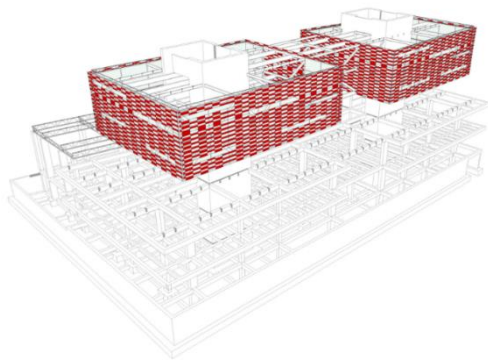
Axonometría - Sistema Paneles de Fachadas
